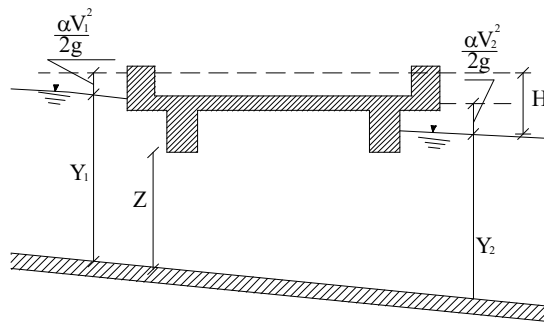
Sezione schematica di un ponte – Schema di calcolo
